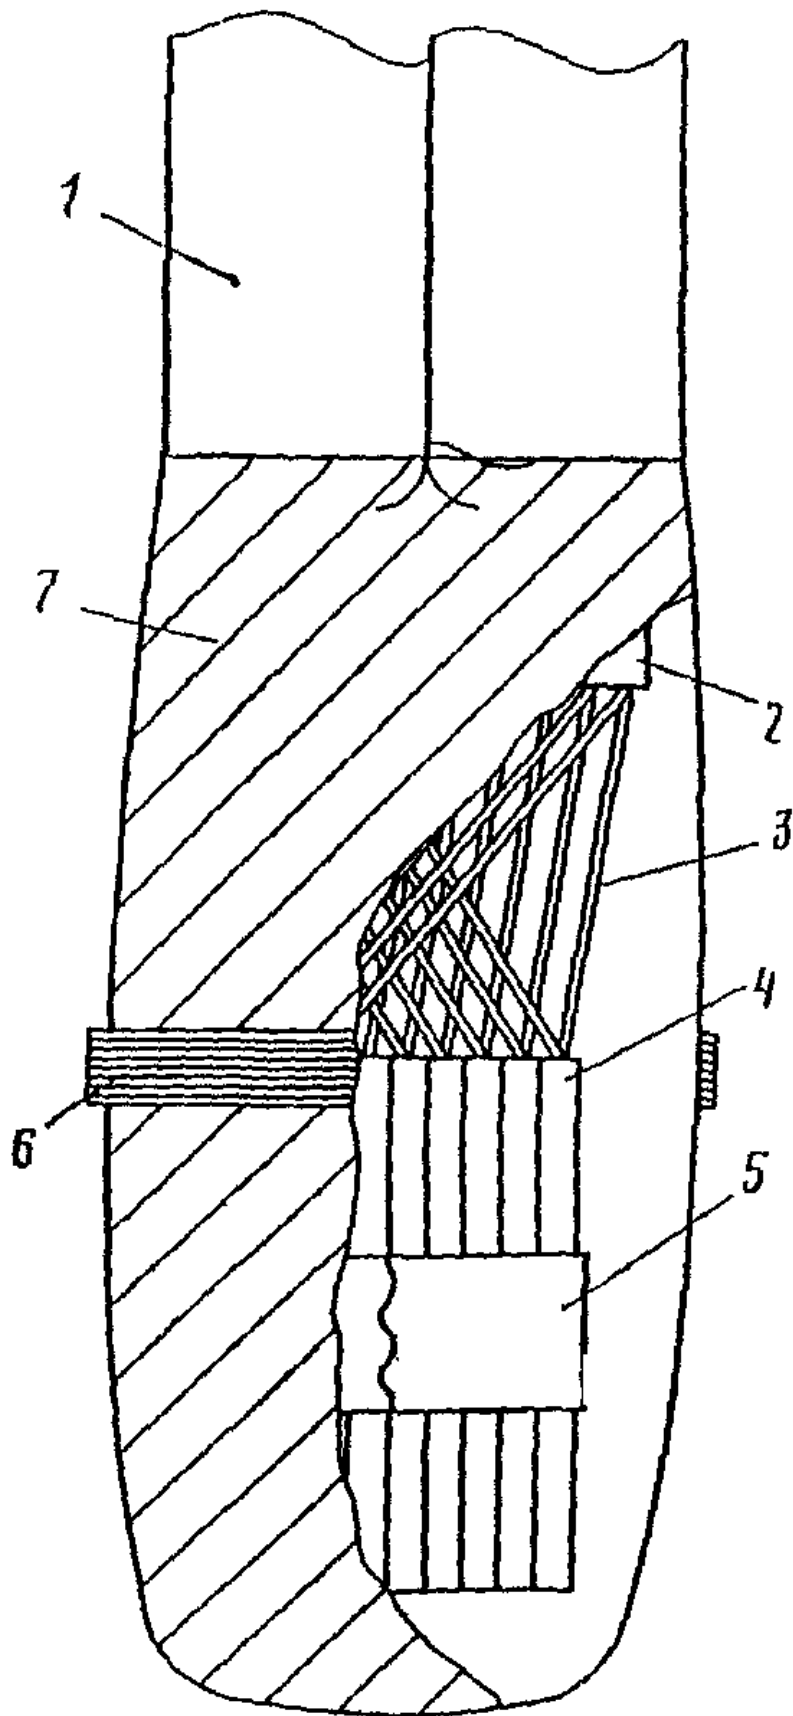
Сросток кабеля, обмотанный стеклолентой: 1 - наружный покров; 2 - оболочка; 3 - изоляция жил; 4 - полиэтиленовые гильзы; 5 - перевязка гильз лентами; 6 - нитки, скрепляющие стеклоленту; 7 - стеклолента
